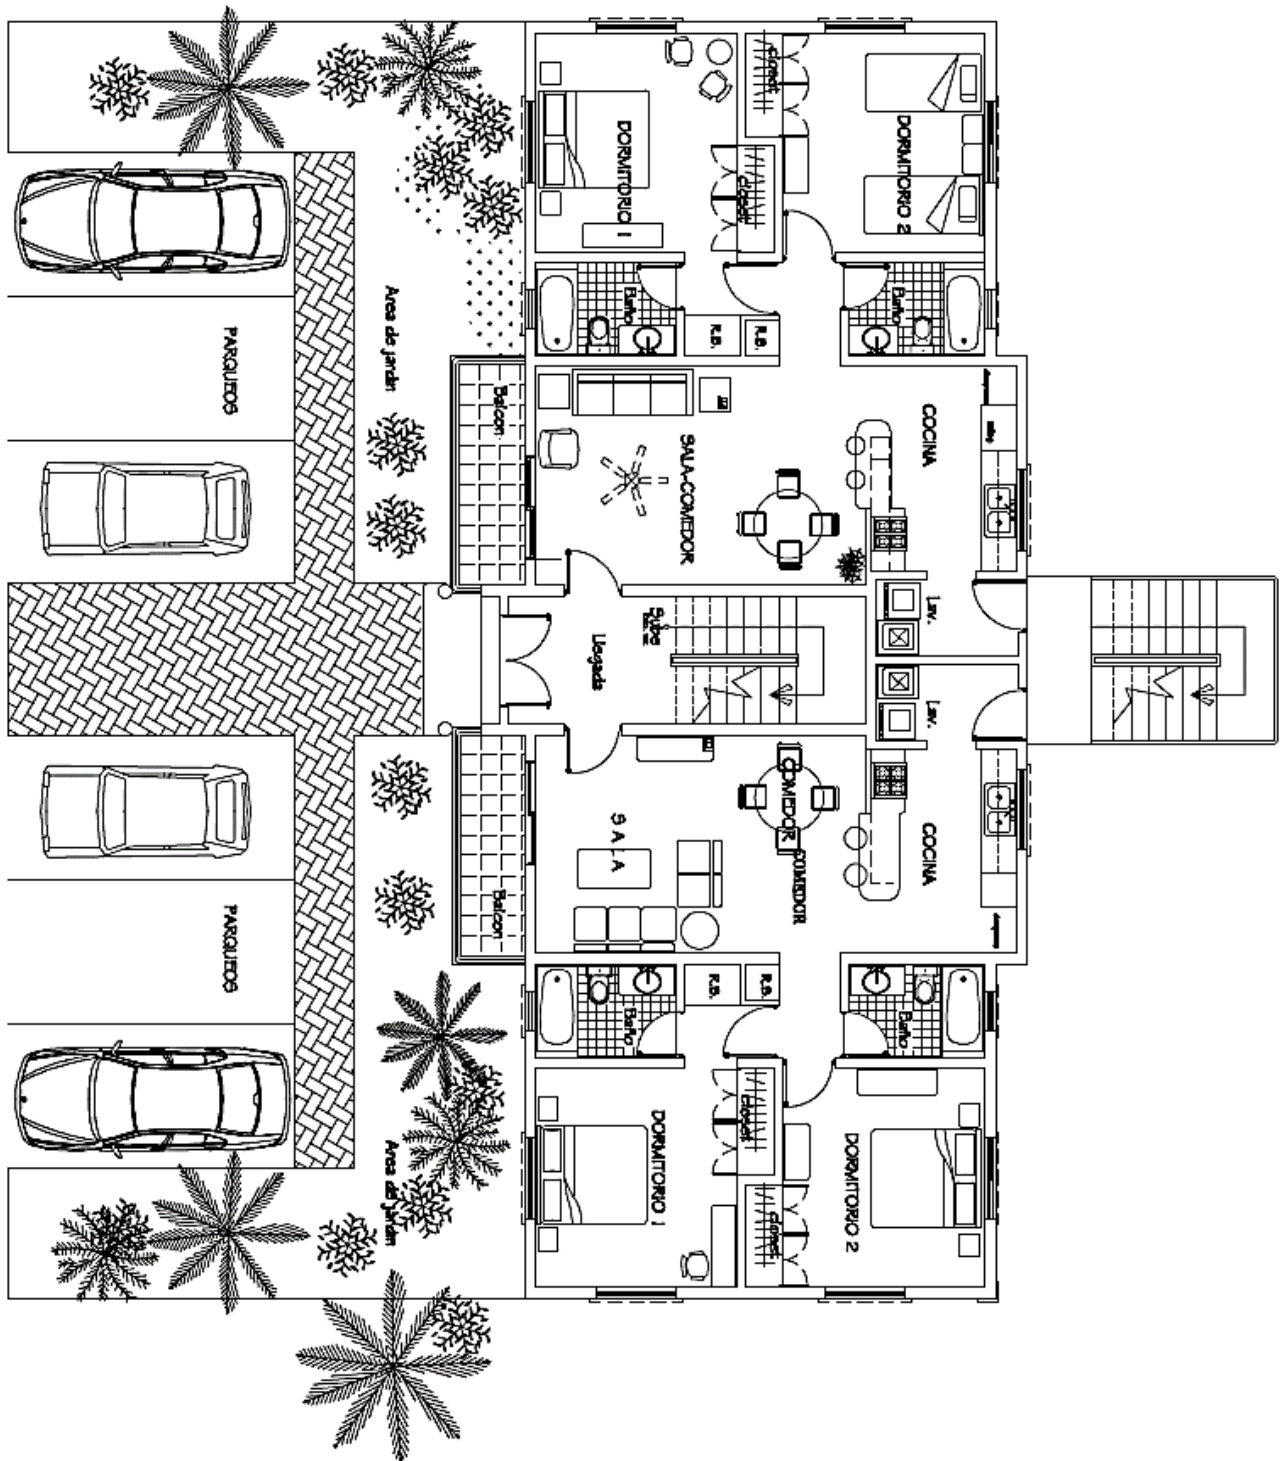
Planta arquitectónica del conjunto total del edificio modelo
